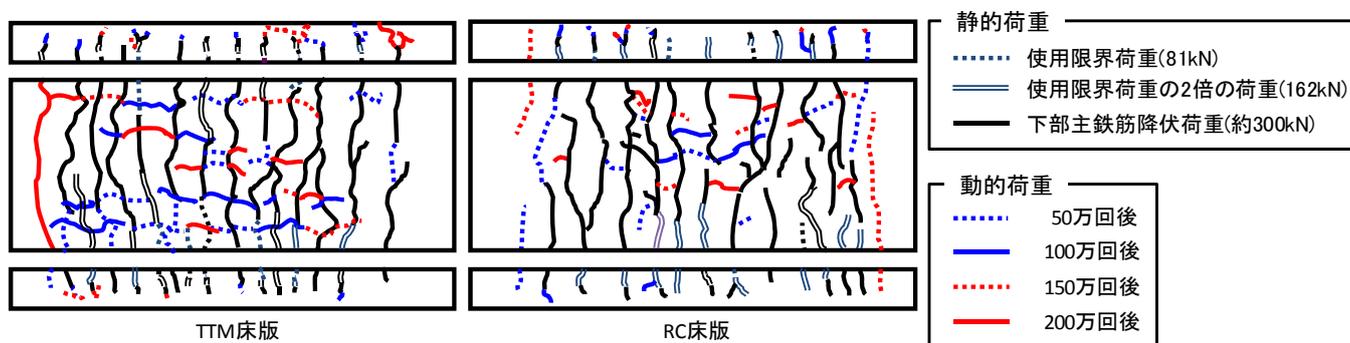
TTM床版およびRC床版に生じたひび割れ
